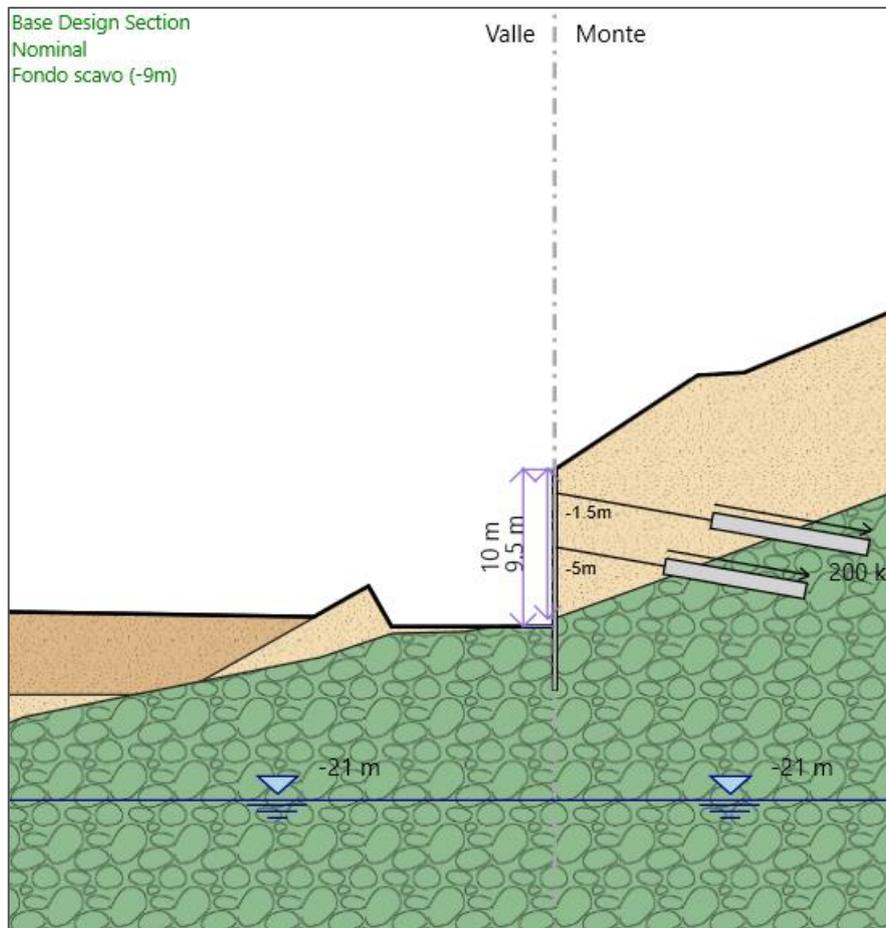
Sezione di progetto di Paratie – Altezza coltre 9,5 m
